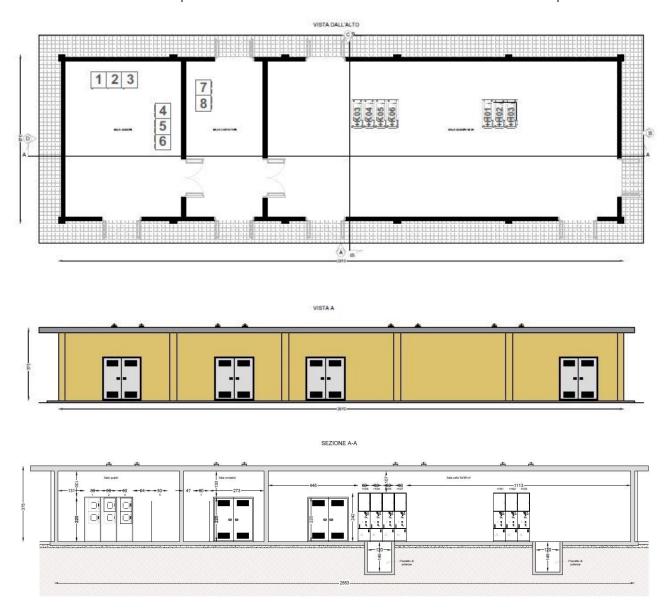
Pianta, prospetto e sezione cabina di trasformazione 30/36 kV
